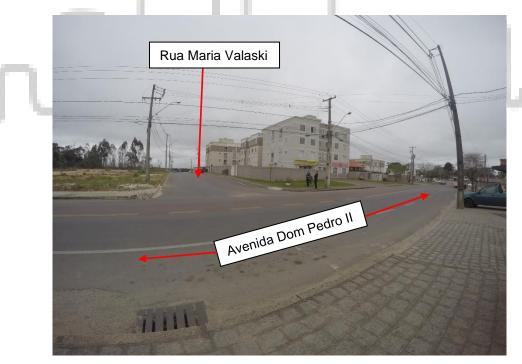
Vista da Rua Maria Valaski a partir da Avenida Dom Pedro II, Quatro Barras - PR. (Fonte própria)
